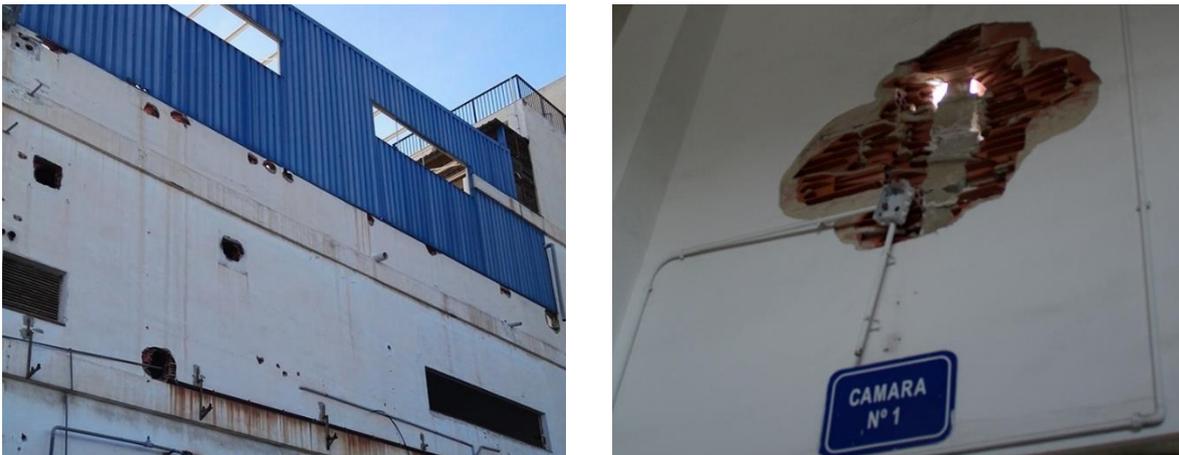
Imagen izquierda. Vista general de roturas y aberturas de huecos en la fachada de la nave II. Imagen izquierda. Rotura en la fachada sureste de la nave II (desde el interior). Fuente: autora.
